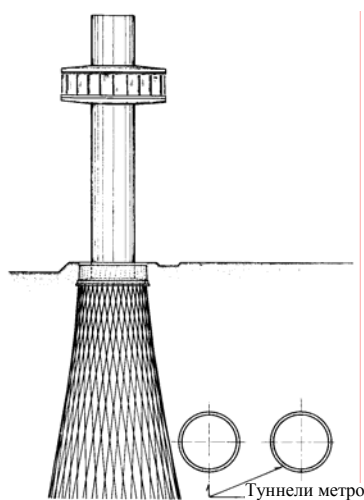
Усиление фундамента панорамной башни в Токио с помощью перекрестных коневидных свай
